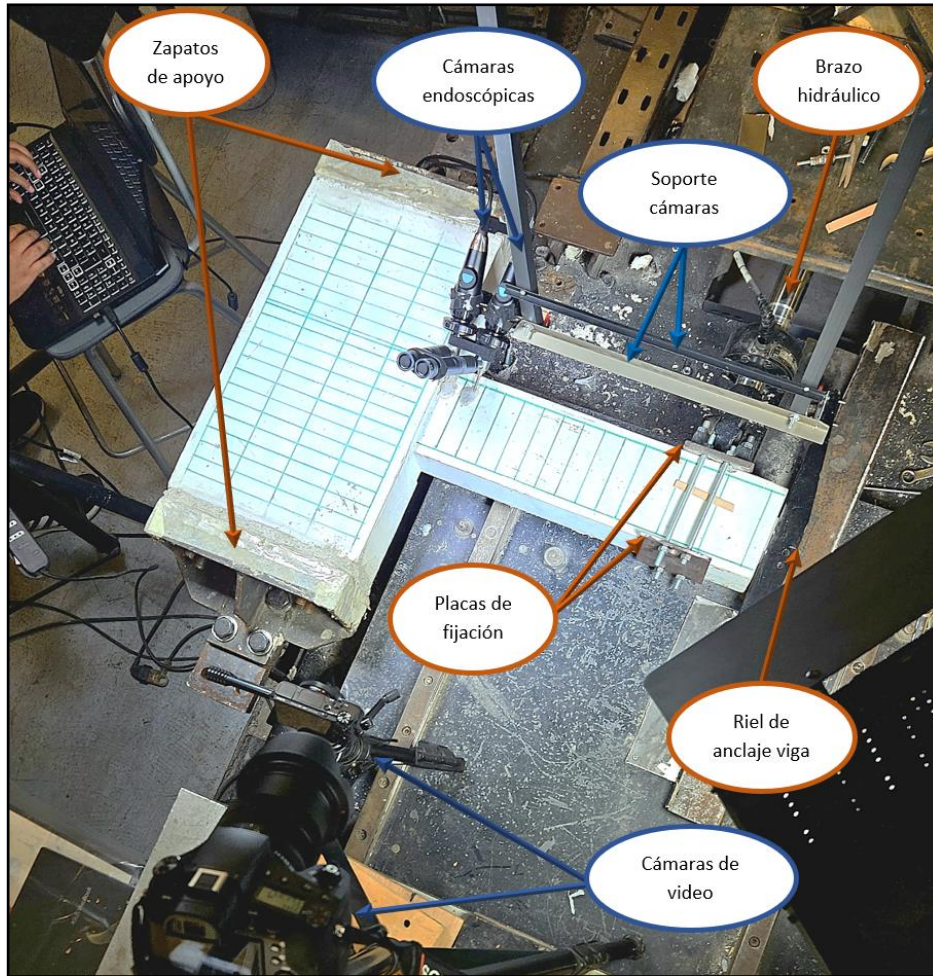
Soporte en voladizo para estudio de deformación de las barras longitudinales con cámaras endoscópicas
